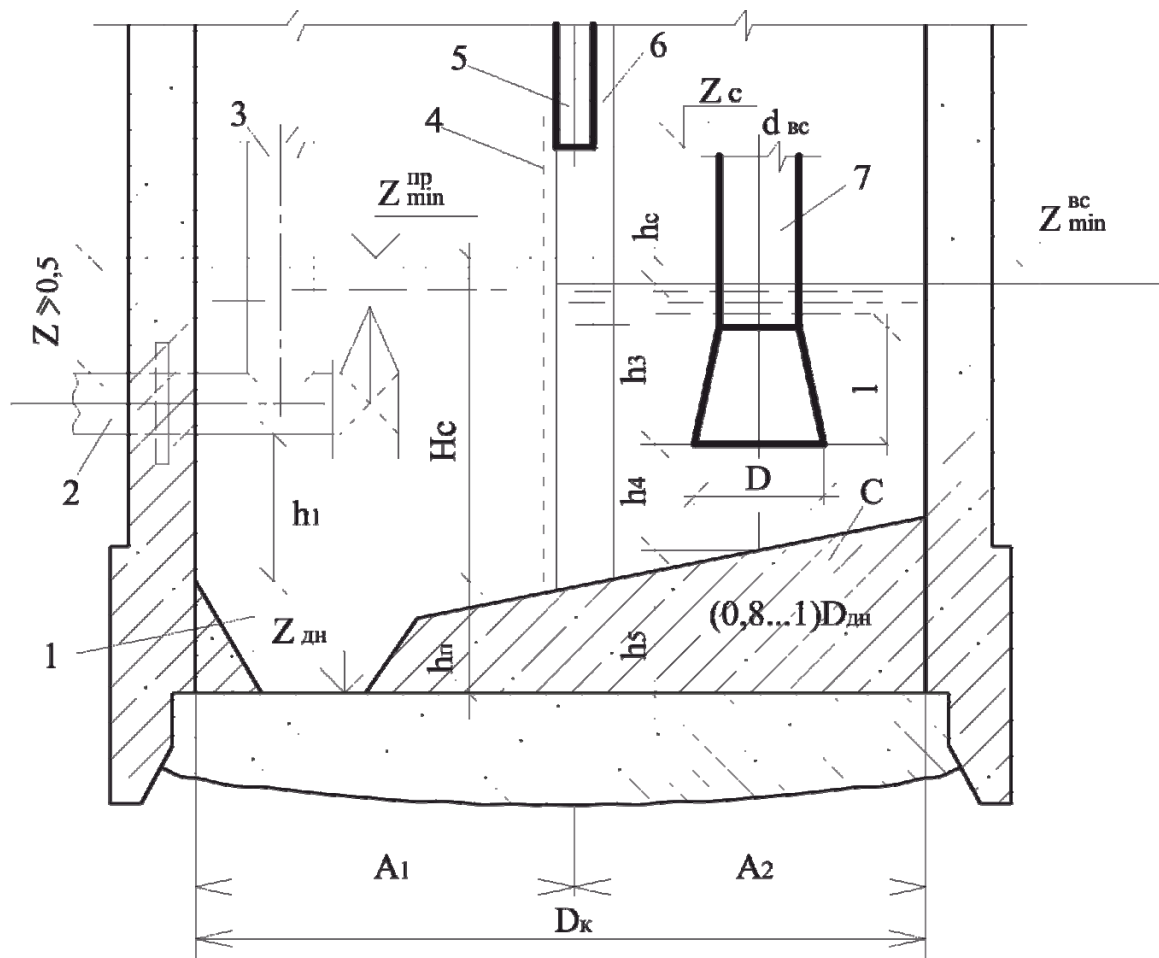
Схема к определению отметки дна берегового колодца:
